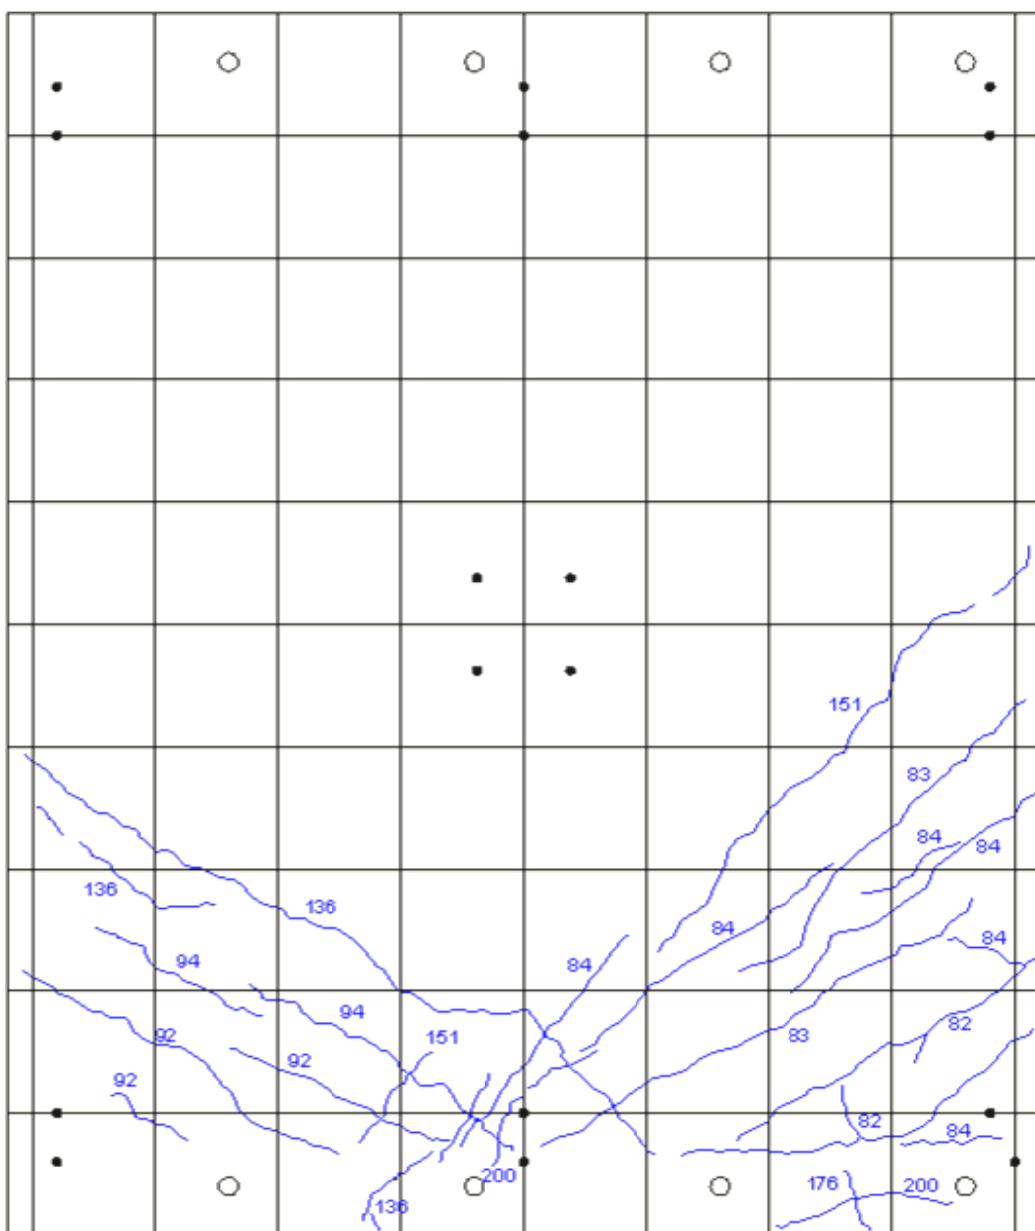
Agrietamiento final del modelo losa 03
